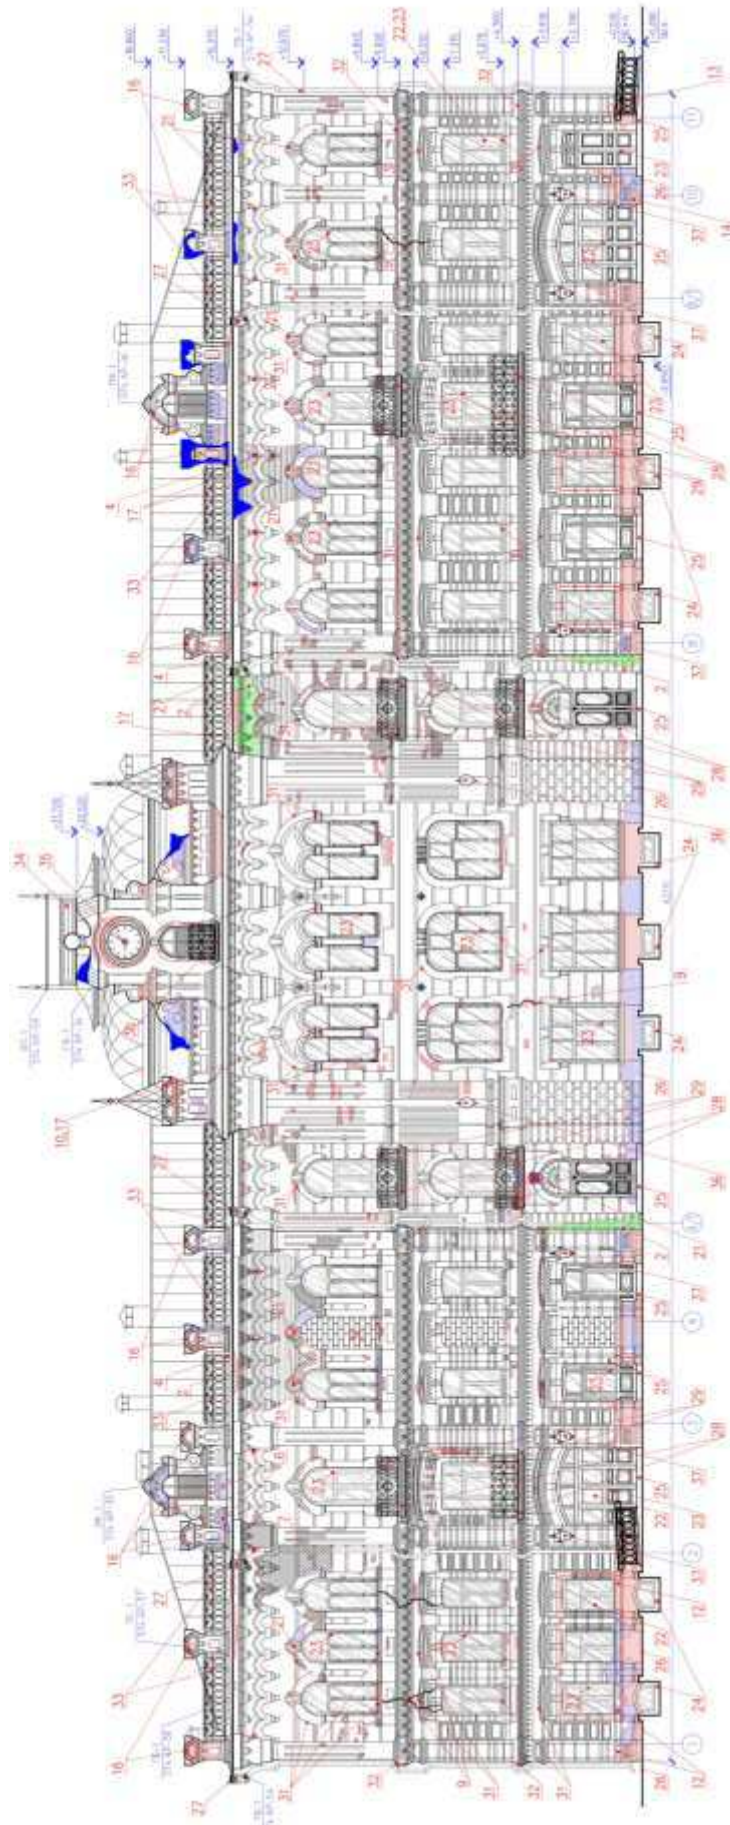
План реконструкции дома Вильнера фасад в осях 1-11 (дворовой фасад)
